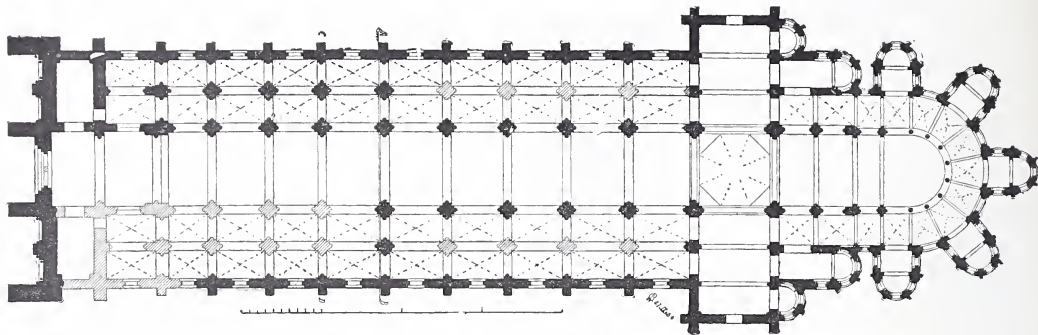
Grundriss von La Charité sur Loire.
